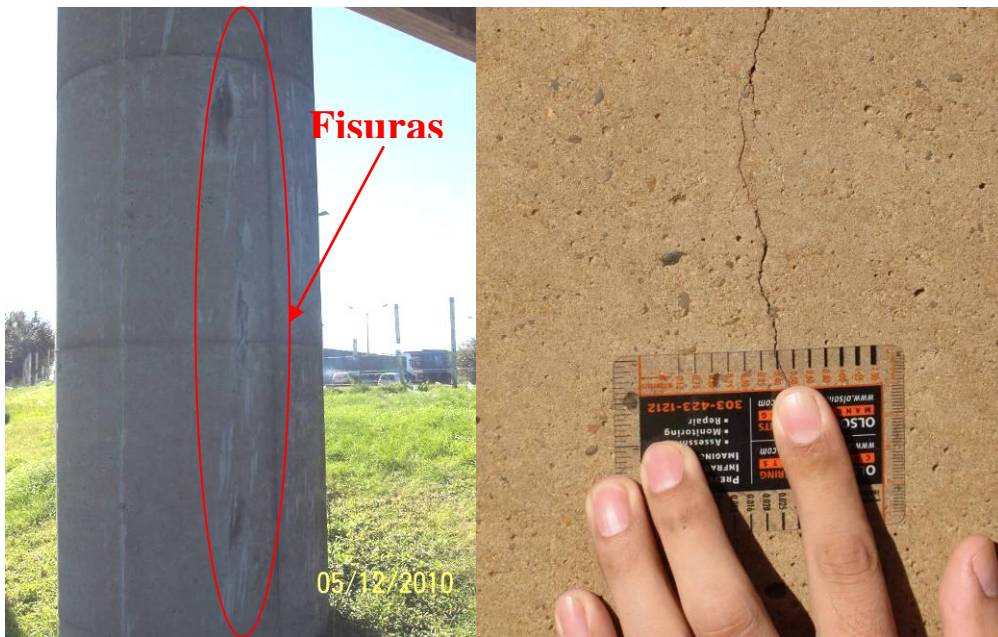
Columna 2, Pila 4 (Lado Uruguayo). Izquierda: se encuentran indicadas las fisuras. Derecha: se observa una imagen de la medición del espesor de la fisura.
